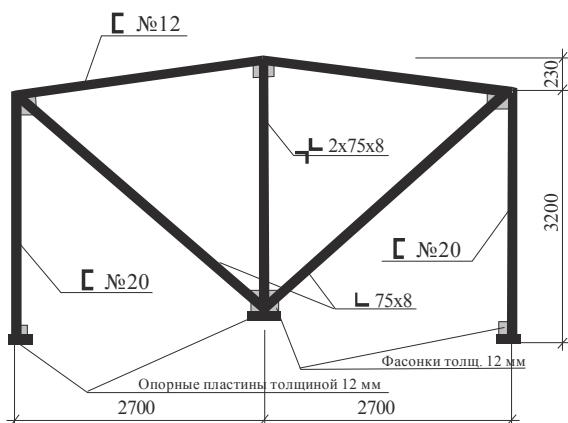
Схема фонарной рамы прямоугольного фонаря
